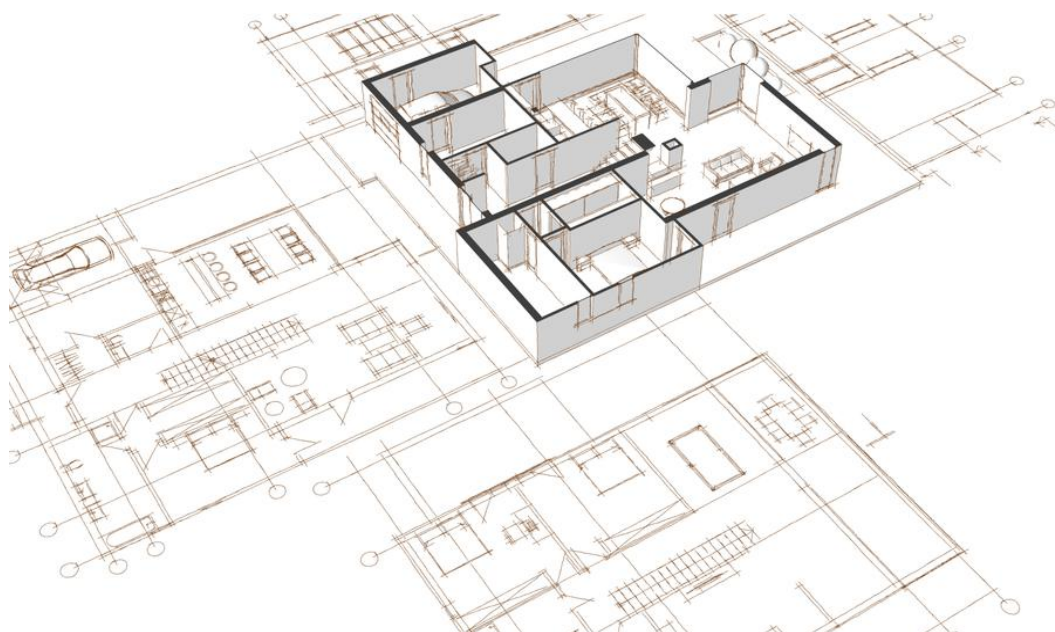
Projeto elaborado em CAD – Sketch 3D.
